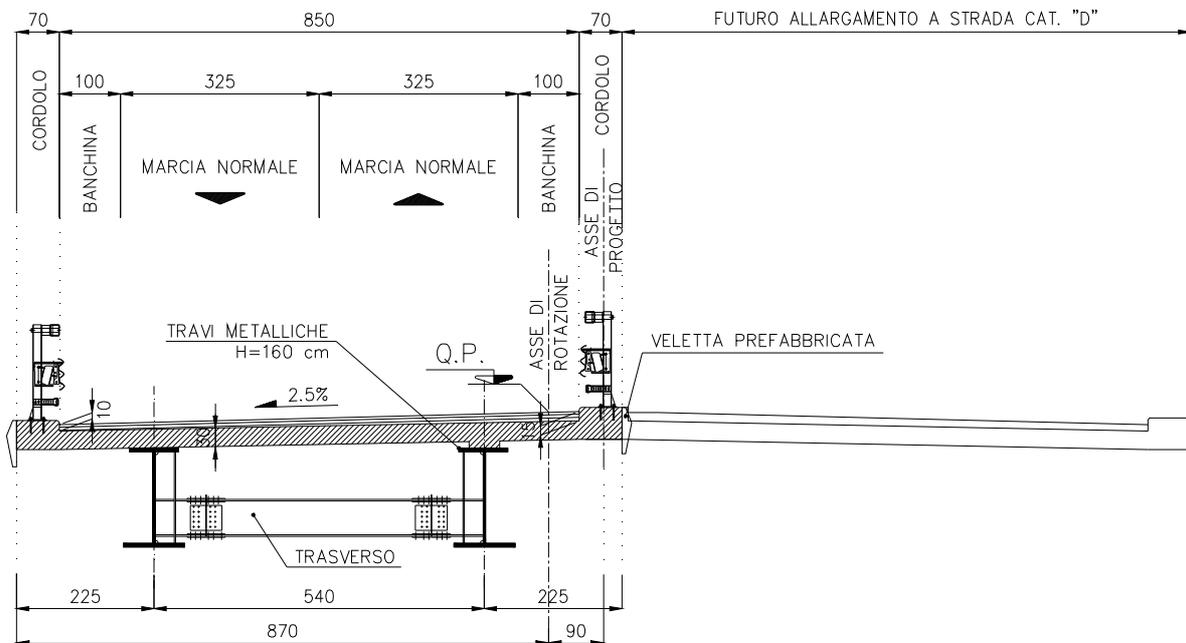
Sezione tipo impalcato Viadotto Cornia Vecchia 2
